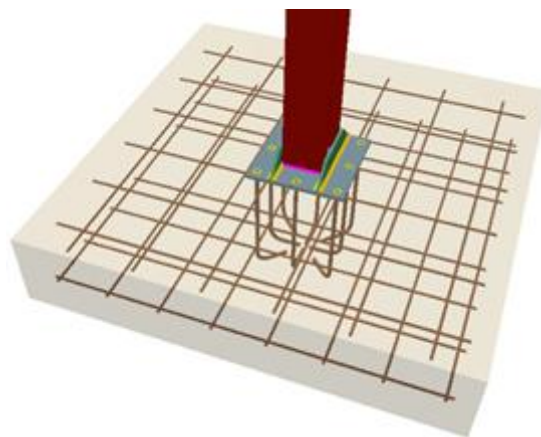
Representación de zapatas de cimentación. Fuente: CYPE. Elaboración propia.
